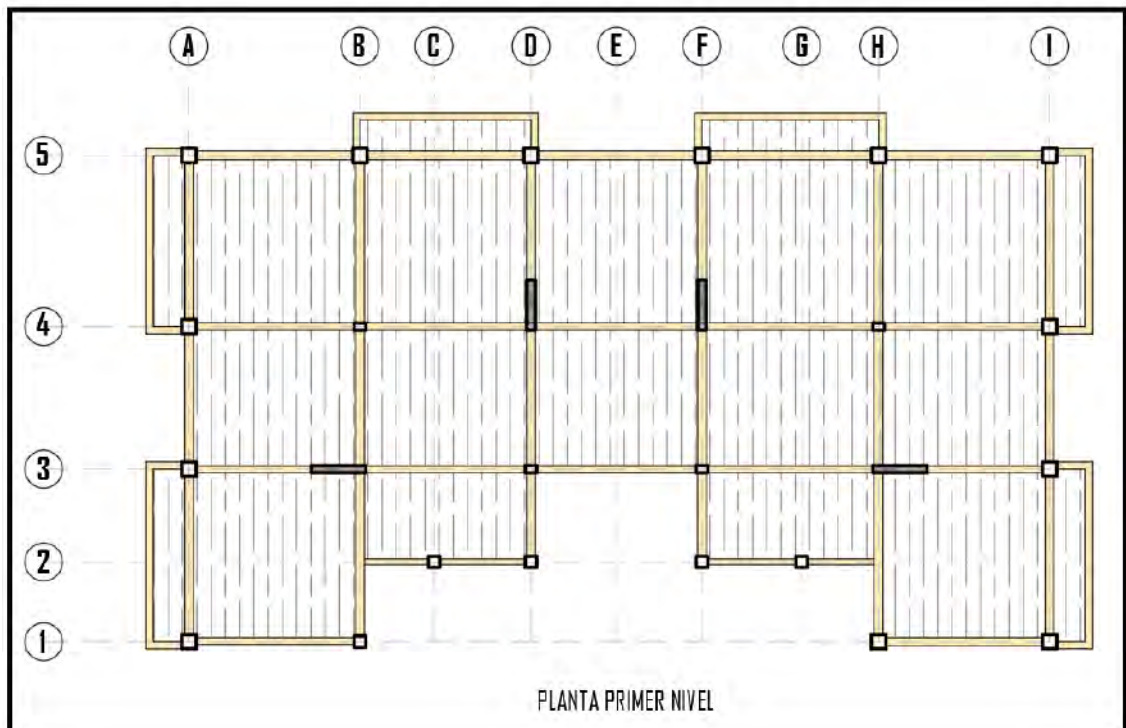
Planta del proyecto de reforzamiento en la UNA-PUNO
